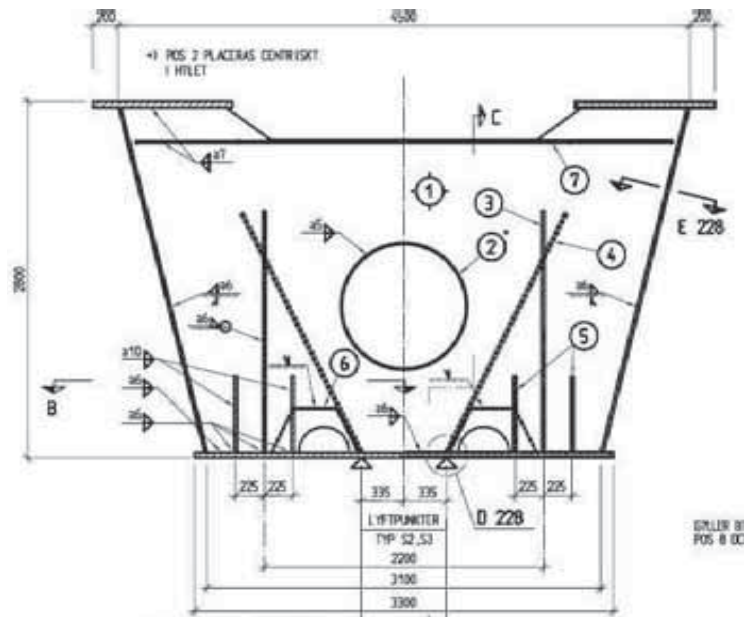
Section transversale et détails au niveau des appuis du pont sur le Vallsundet.
